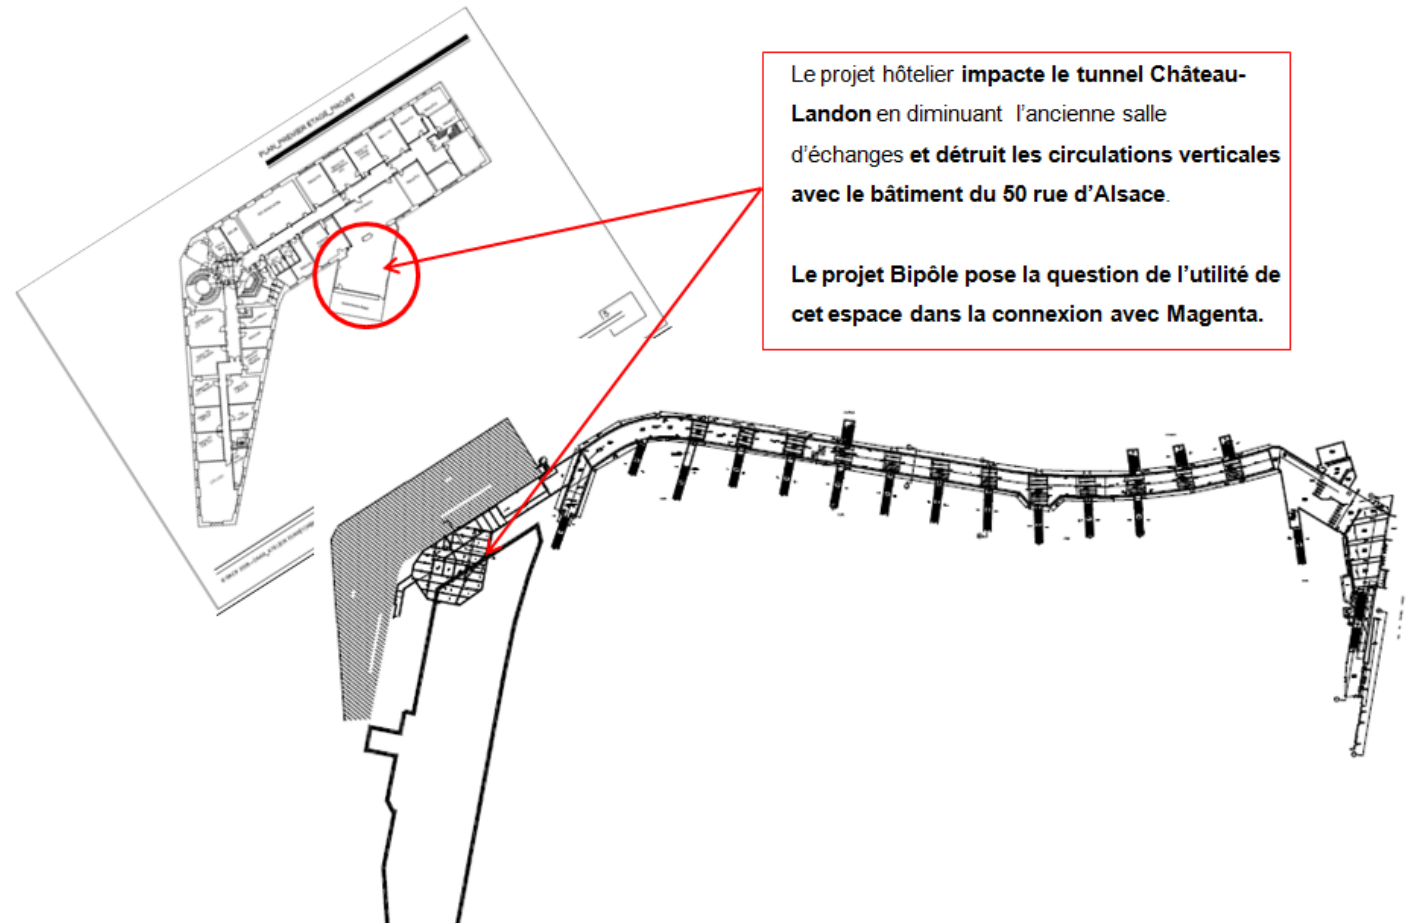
Impact du projet hôtelier Balcon Vert sur le tunnel Château-Landon
